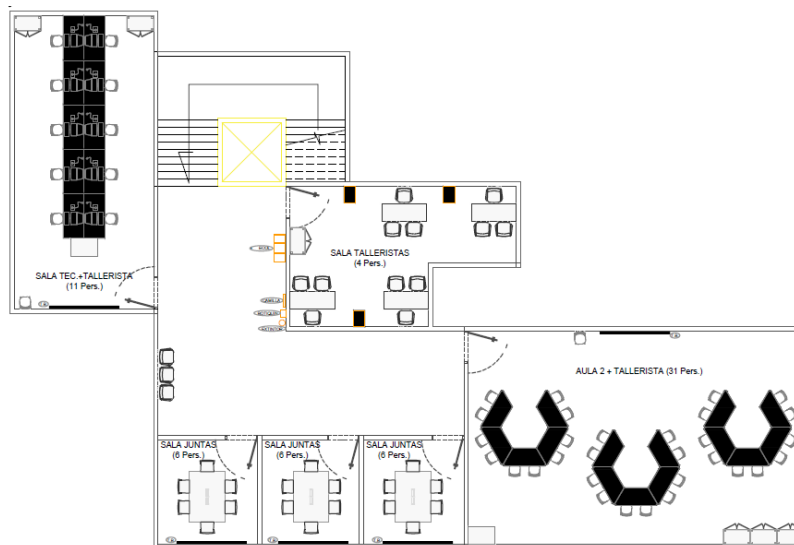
Propuesta Arquitectónica Sacúdete Tipo III – Piso 2
